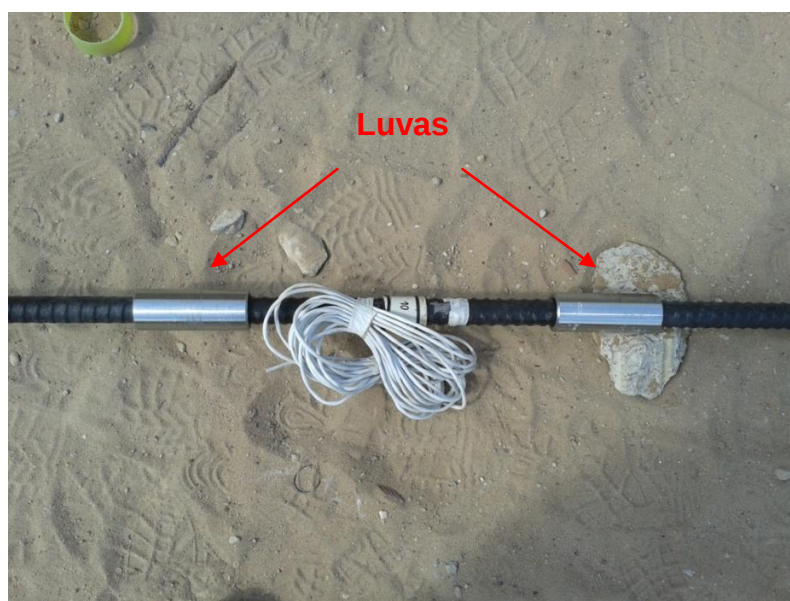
Barra instrumentada emendadas por luvas metálicas.
